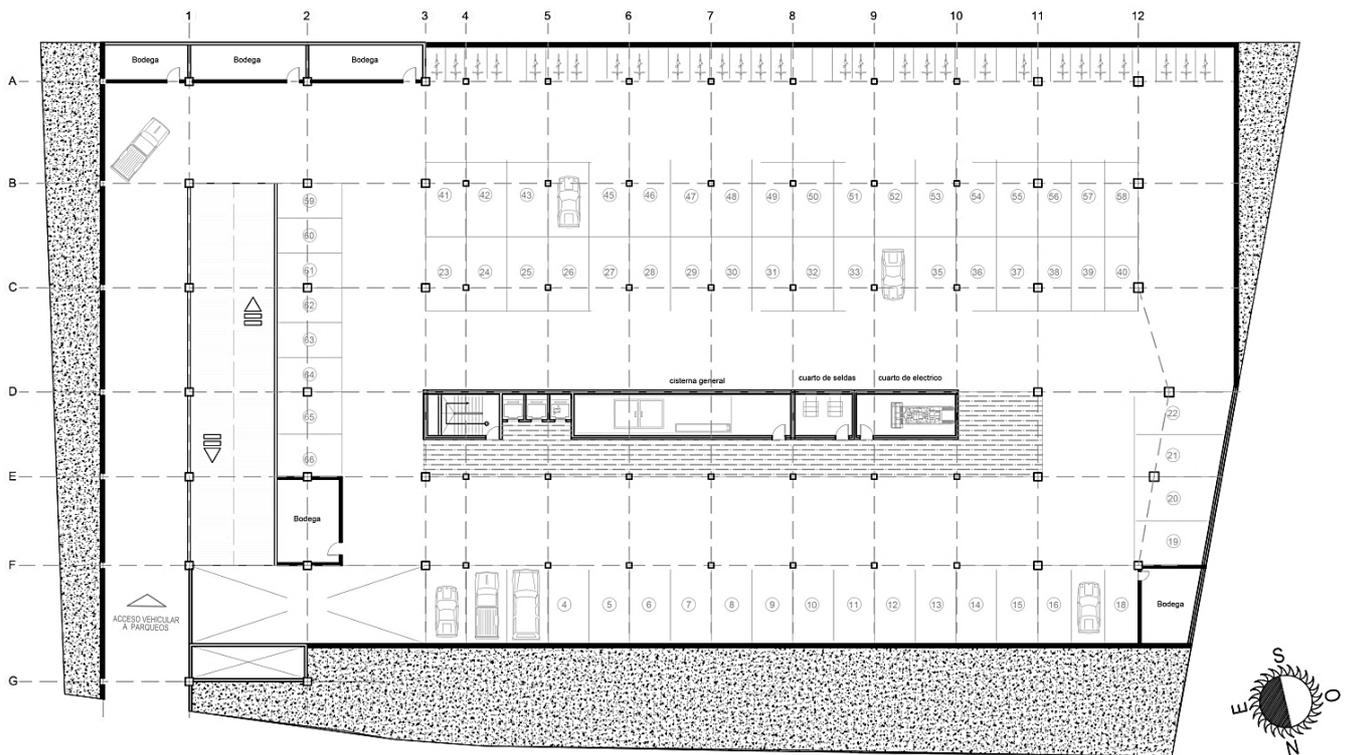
Planta Subsuelo 1 Cevallos. (2018). Creación propia
